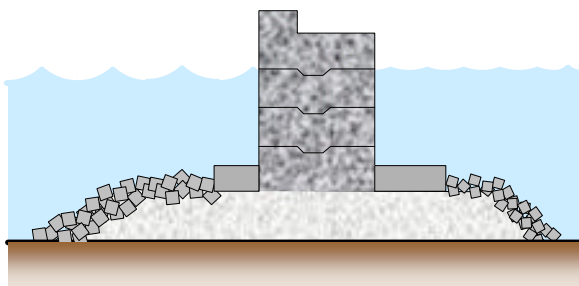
Sección transversal de un dique vertical, en este caso, cimentado sobre un fondo de escollera.
